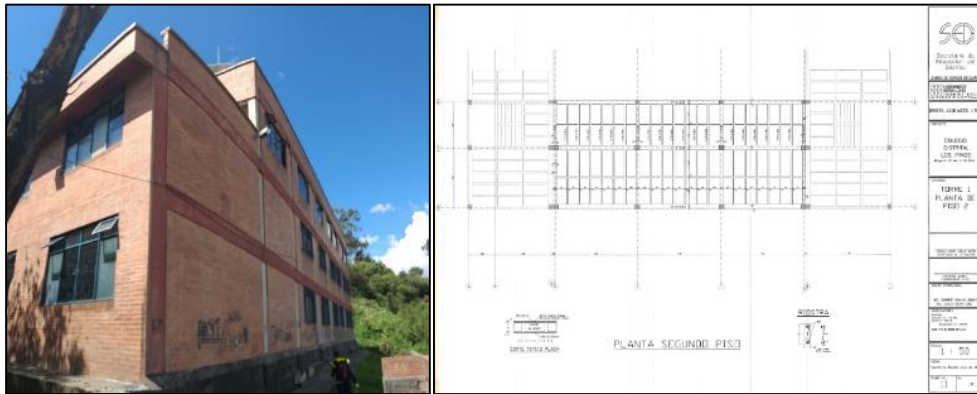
Sistema estructural. I.E.D. Los Pinos Sede A.
